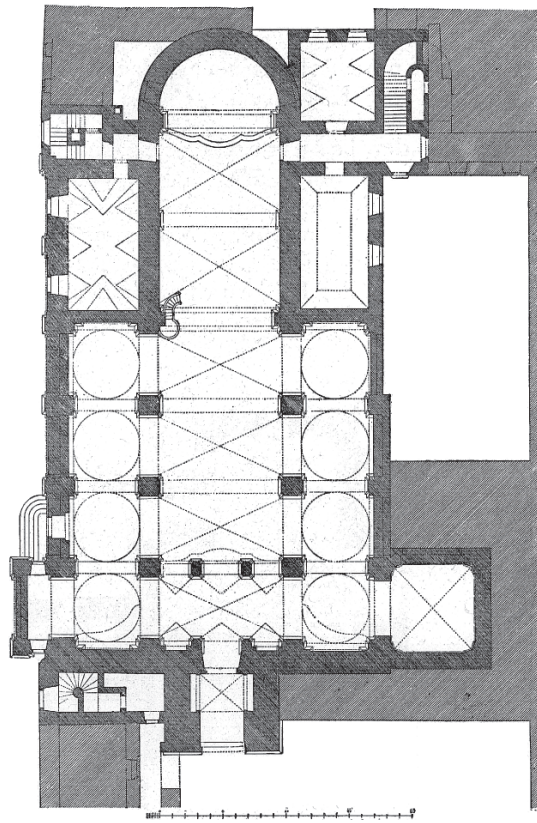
Brünn, Jesuitenkirche, Grundriß
